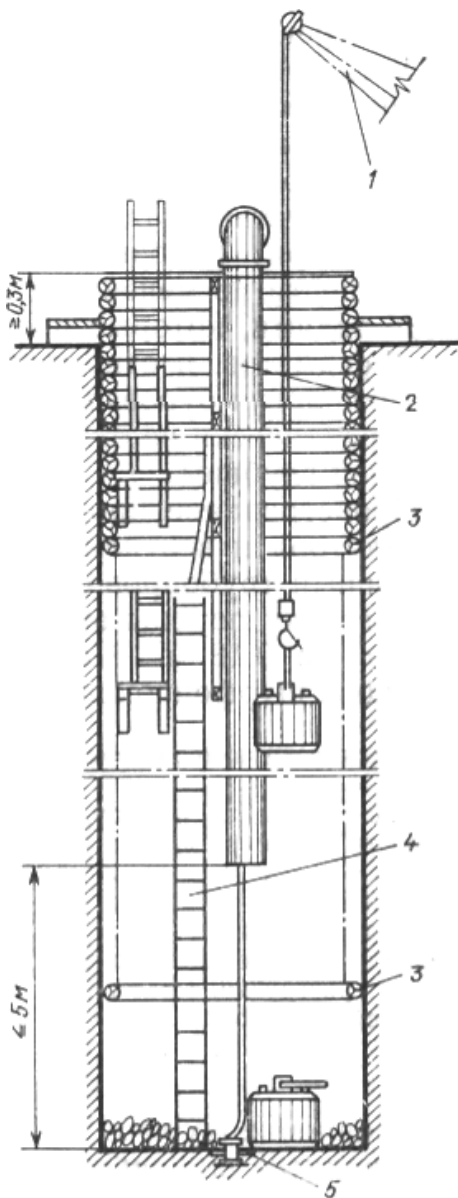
Схема проходки глубоких шурфов буровзрывным способом: 1 – шурфопроходческий подъемник; 2 – вентиляционный трубопровод; 3 – венцы; 4 – подвесная лестница; 5 – погружной забойный насос
